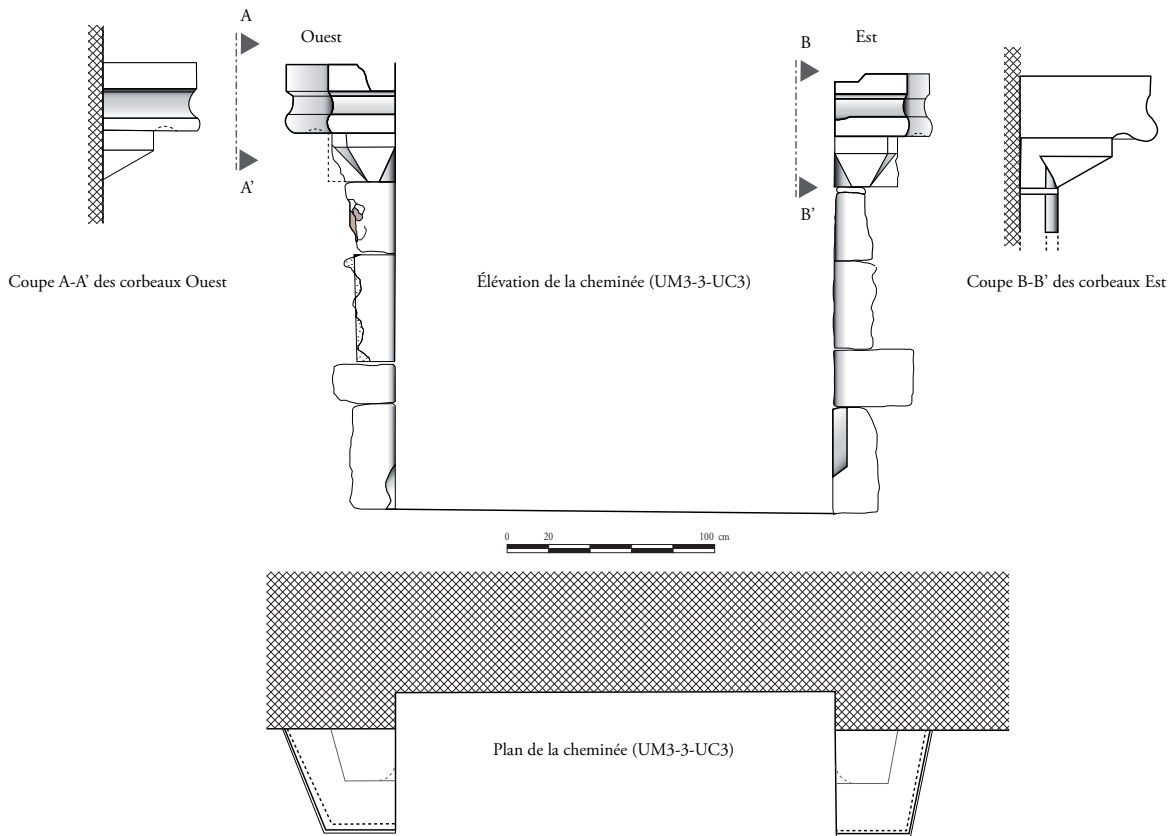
a:Élévation, plan et profils de la cheminée nord du 3^e niveau
